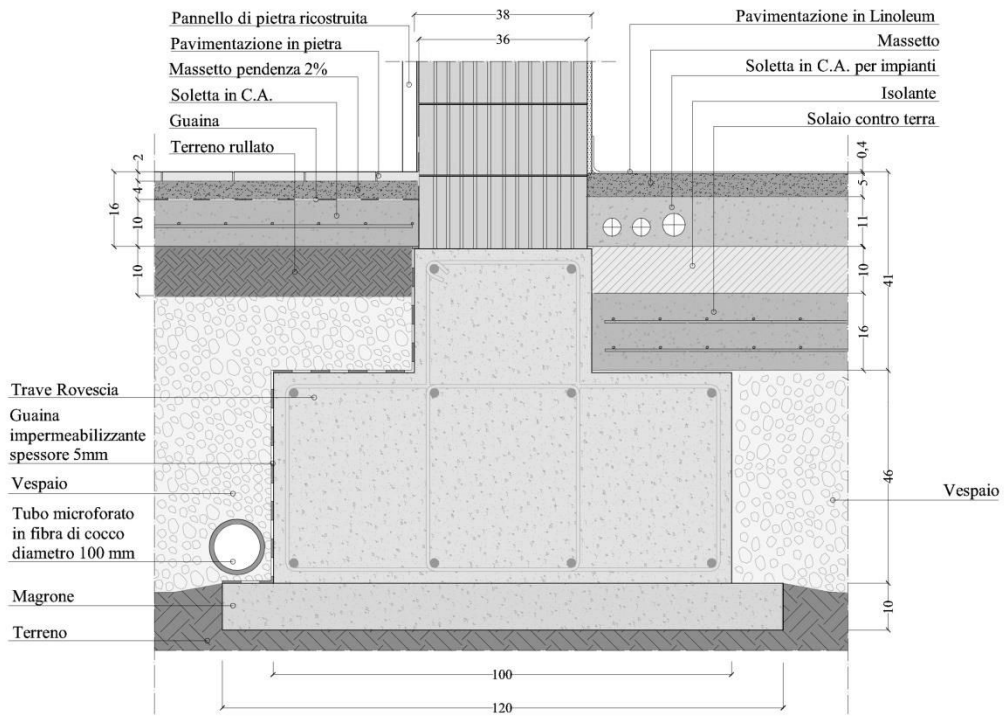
Dettaglio solaio controterra e fondazione.
